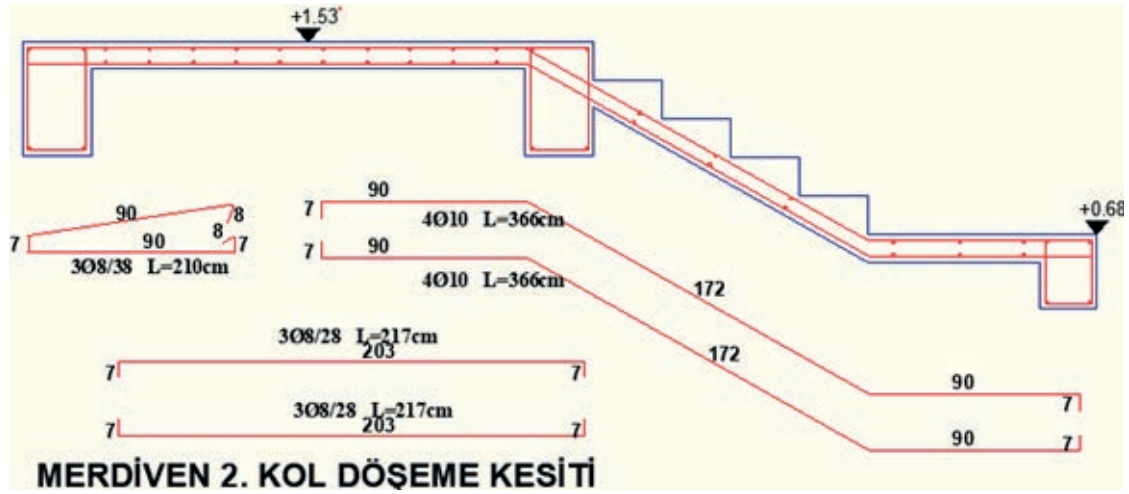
Merdiven kirişi 3 donatı açılımı
